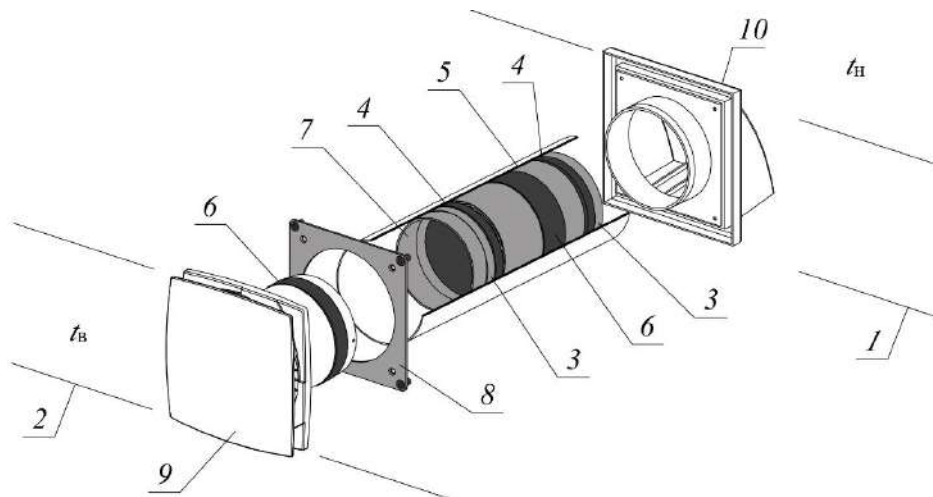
Схема стенового приточного клапана с реверсом: 1, 2 – наружная и внутренняя стены; 3 – выпрямители потока; 4 – фильтры; 5 – регенератор; 6 – уплотнитель; 7 – дистанционное кольцо; 8 – шасси; 9 – реверсивный вентилятор; 10 – колпак
